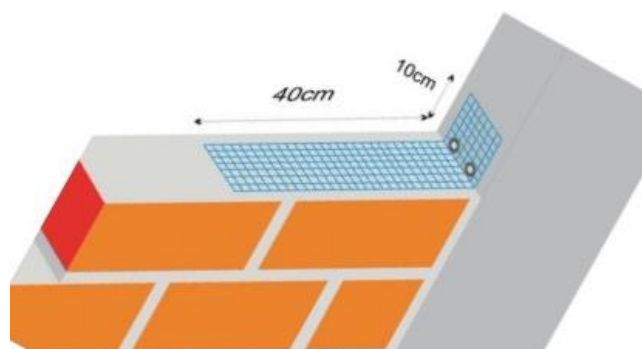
Detalhe de ligação estrutura/alvenaria com tela galvanizada
